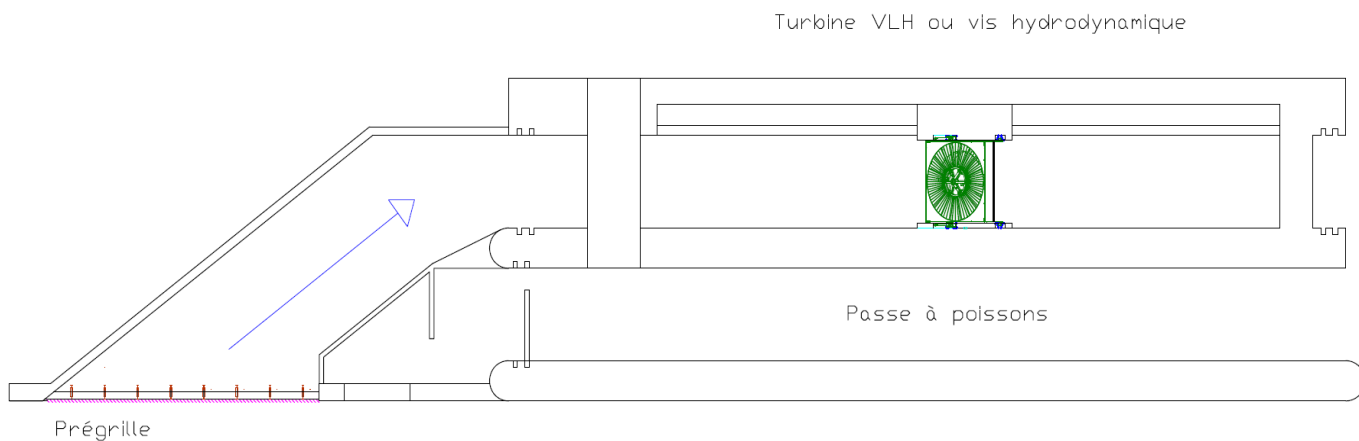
Vue d'ensemble du cheminement d'eau vers la turbine
